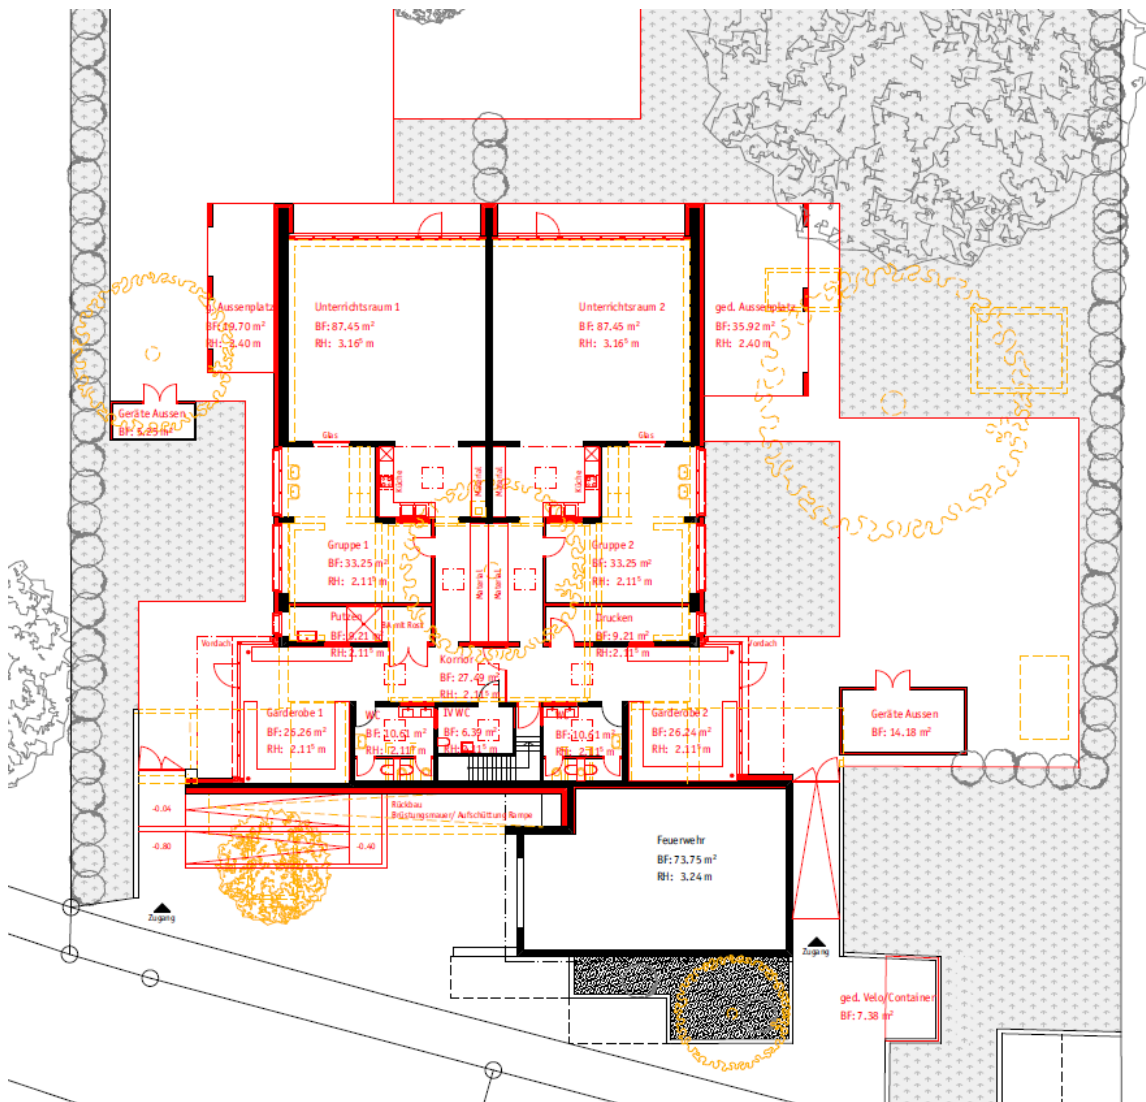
Grundrissplan 2025 Sanierung Kindergarten Goldern, Husstein u. Partner
